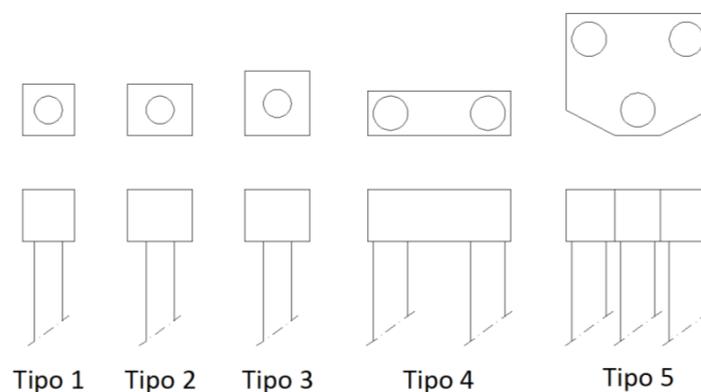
Esquema de tipos de encepado. (Fuente: AMA)
